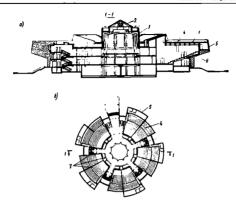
Конструктивная схема каркасного здания из монолитного железобетона:
